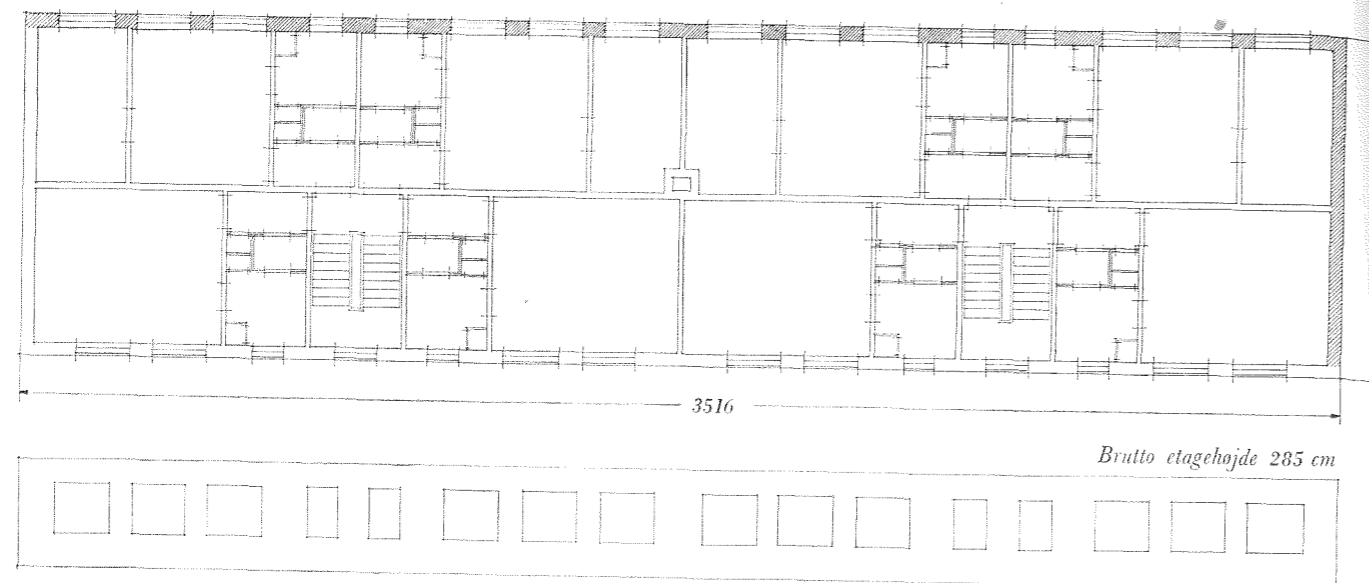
Skitse af den etageplan og facade der har dannet grundlaget for beregningerne af ydervæggens pris. Mål 1:200.
